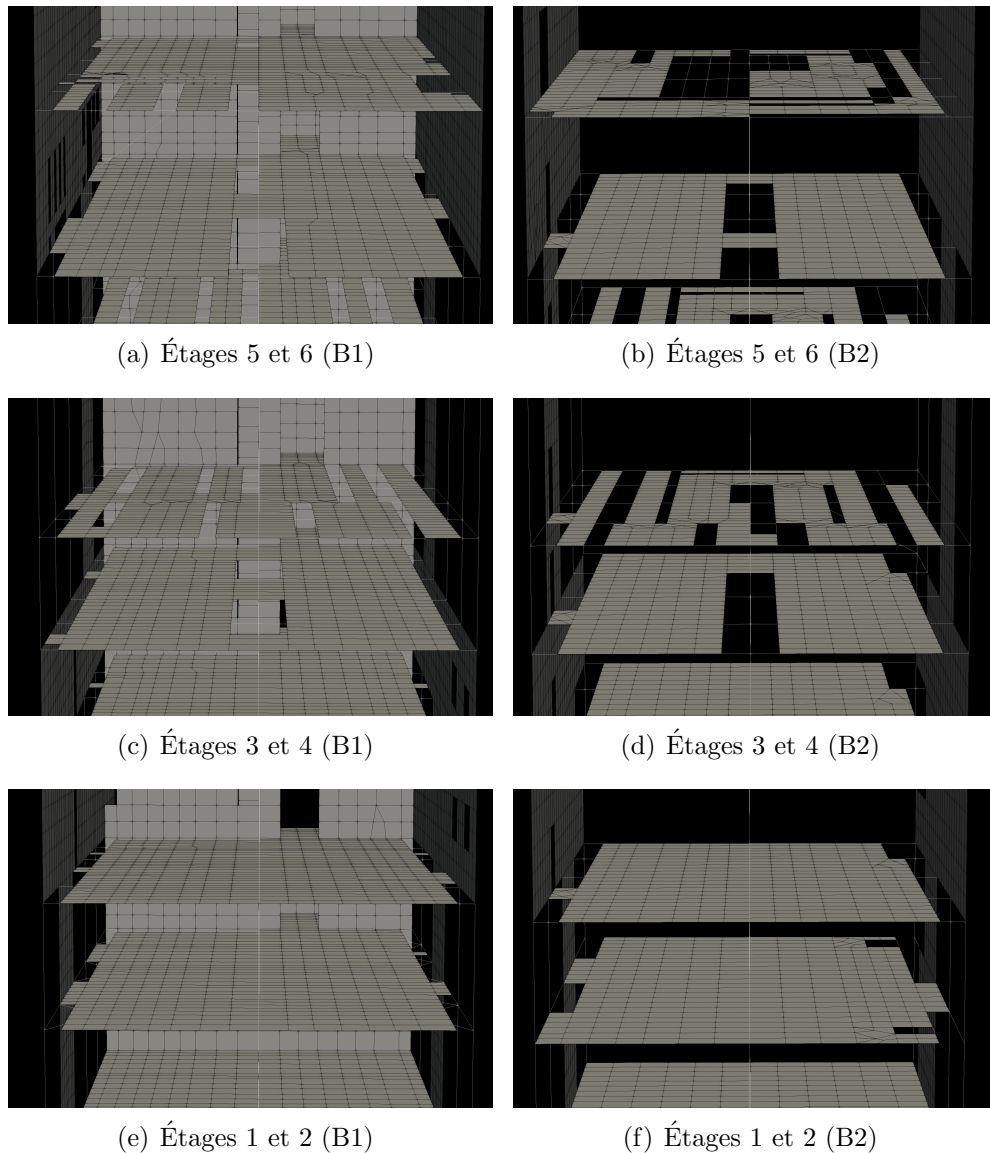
Zoom sur les connections plancher-voile des étages de 1 à 6 des bâtiments B1 et B2
